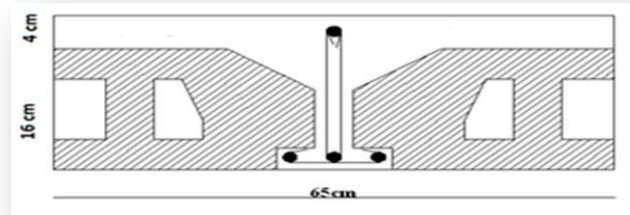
Schéma de position des éléments de plancher corps creux
